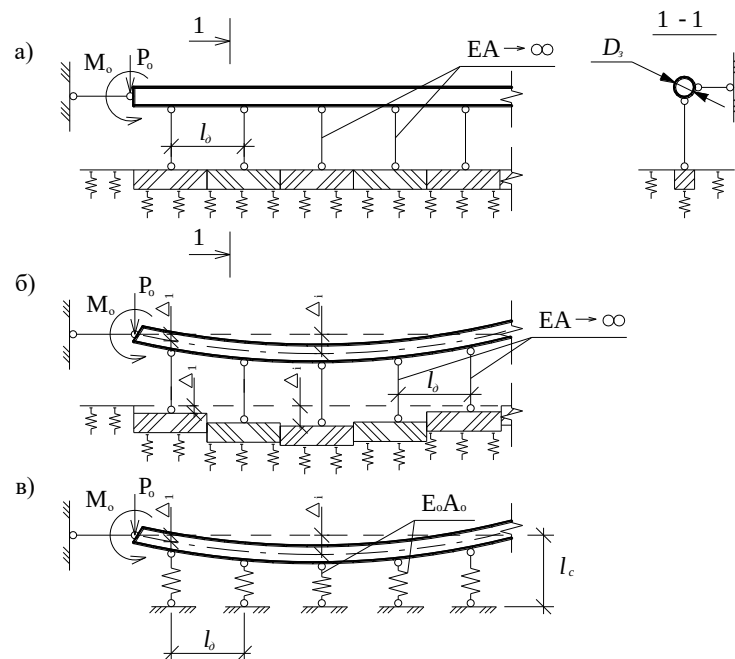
Фрагменти розрахункових схем підземного трубопроводу:
